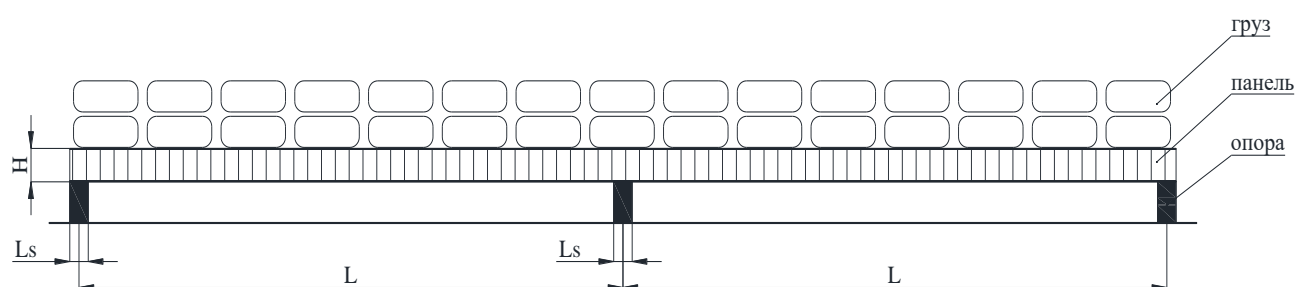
Схема натурных испытаний для двухпролетной панели
